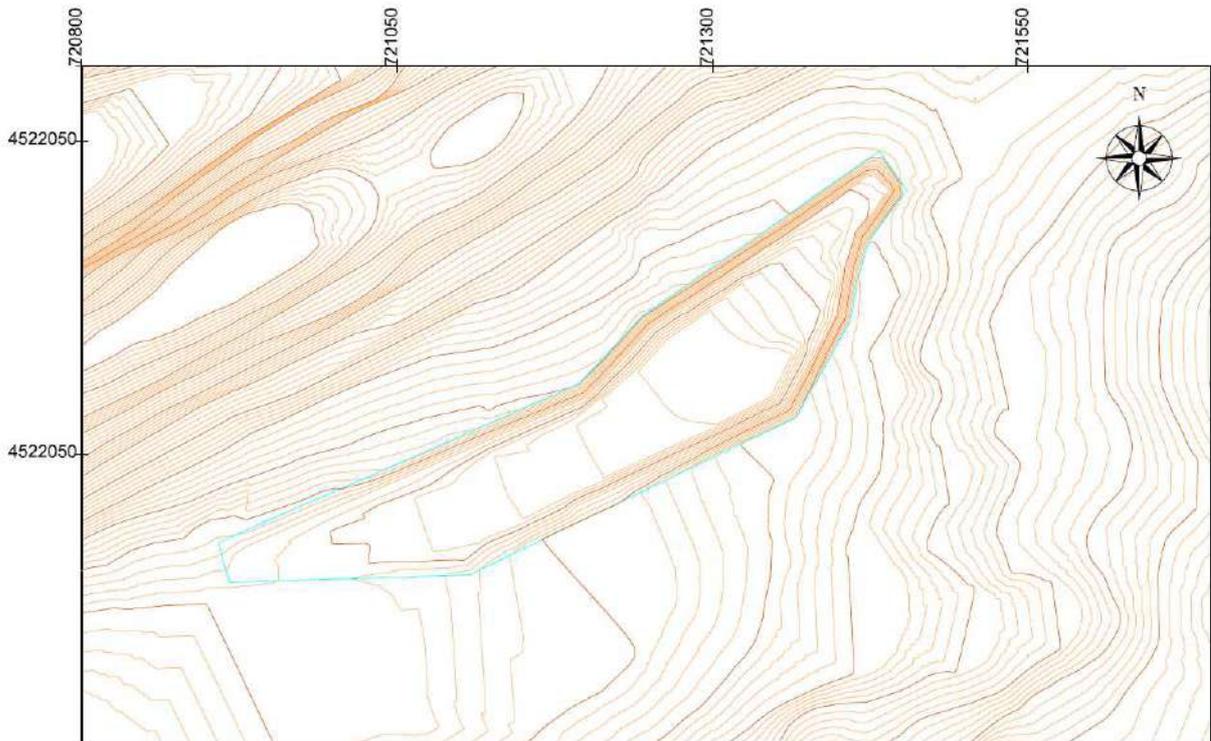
Geometría del diseño final de la Zona III tras la restauración.
